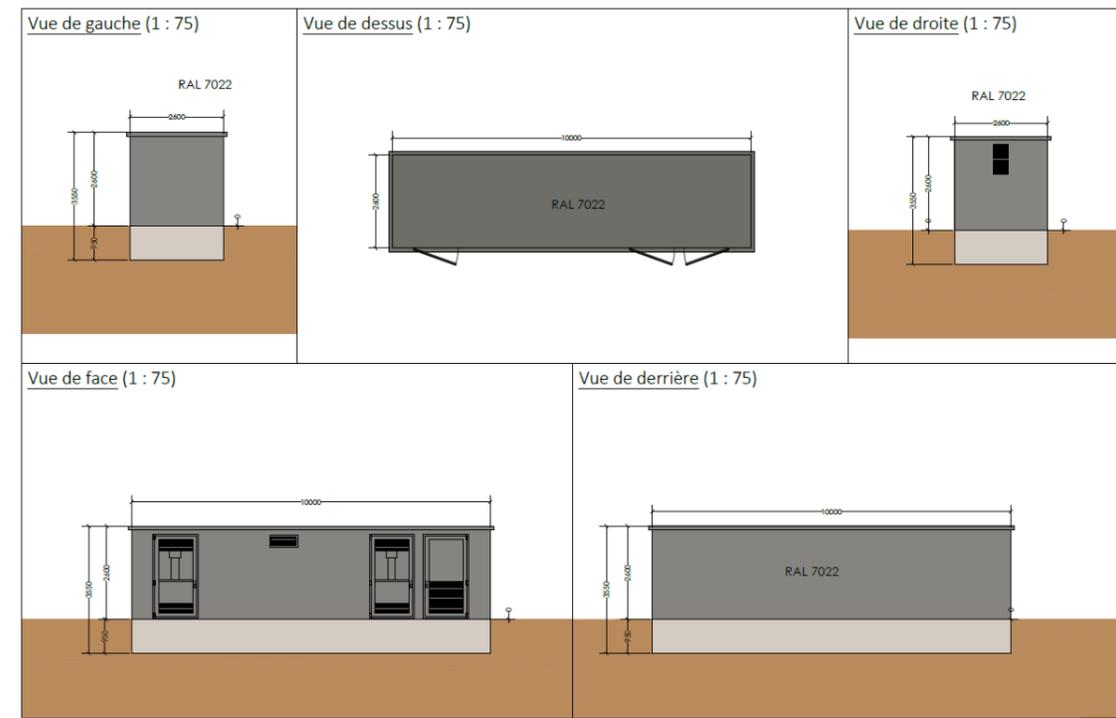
Plan de coupe et façades d'un poste de livraison
